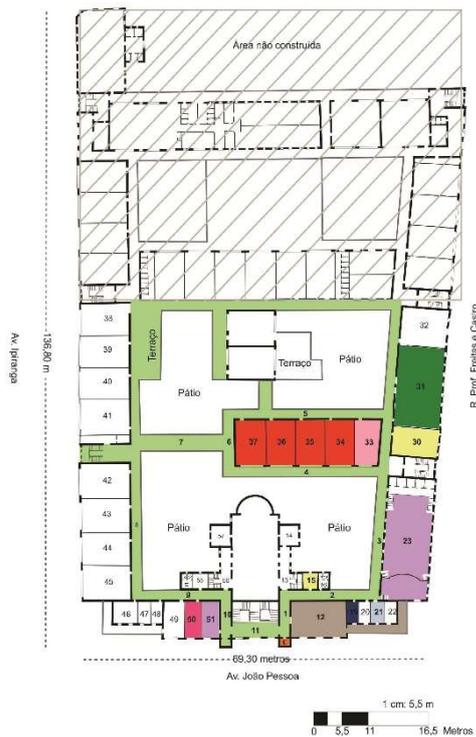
Planta do Instituto Santa Luzia de 1947. Desenho: Luísa D'Ávila, 2017.
